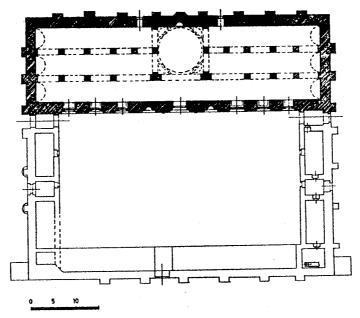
مسقط أفقي لجامع تاريخانه (طارق خانه) بدمغان . (عن : Creswell) .
